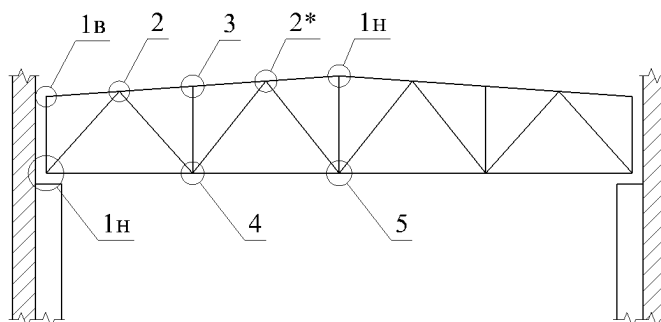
а. Схема опирания легкой фермы на пилястру кирпичной стены
